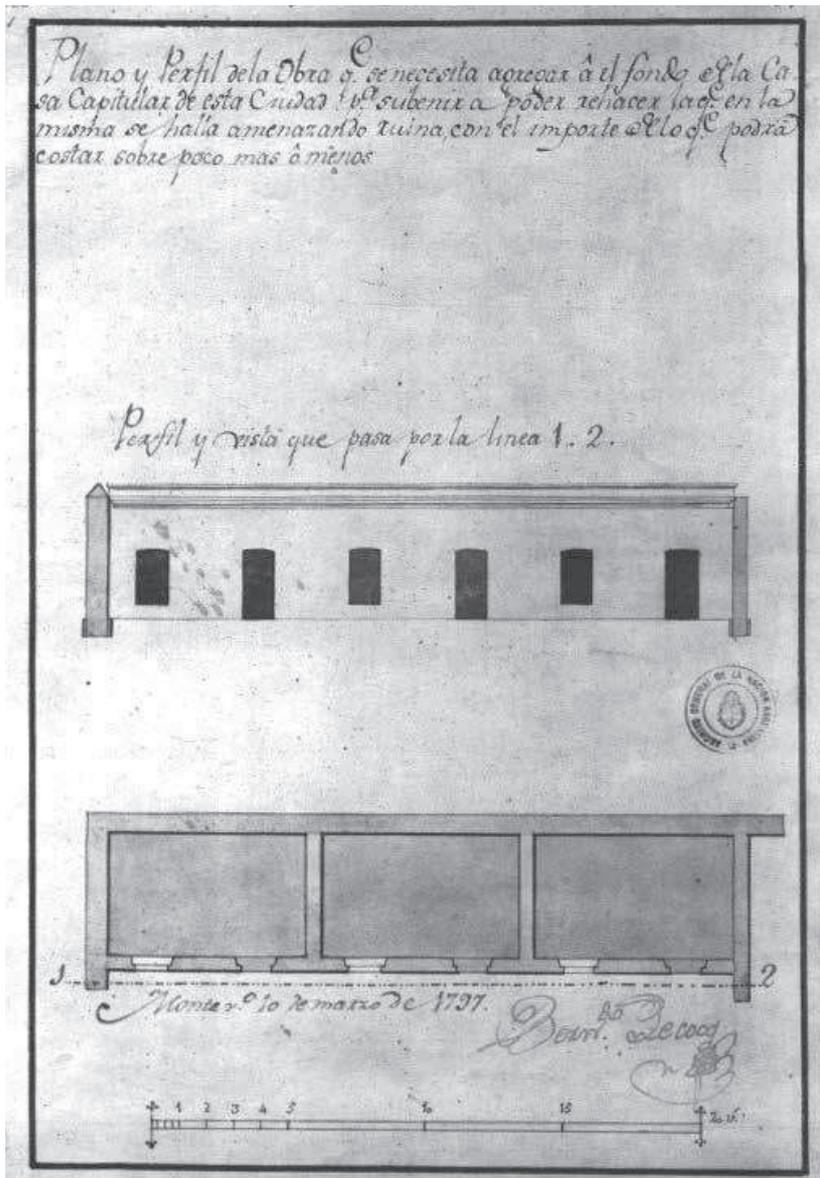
PLANO Y PERFIL DE CONSTRUCCIÓN INCORPORADA AL FONDO DE LA CASA CAPITULAR, FIRMADO POR B. LECOCQ.
